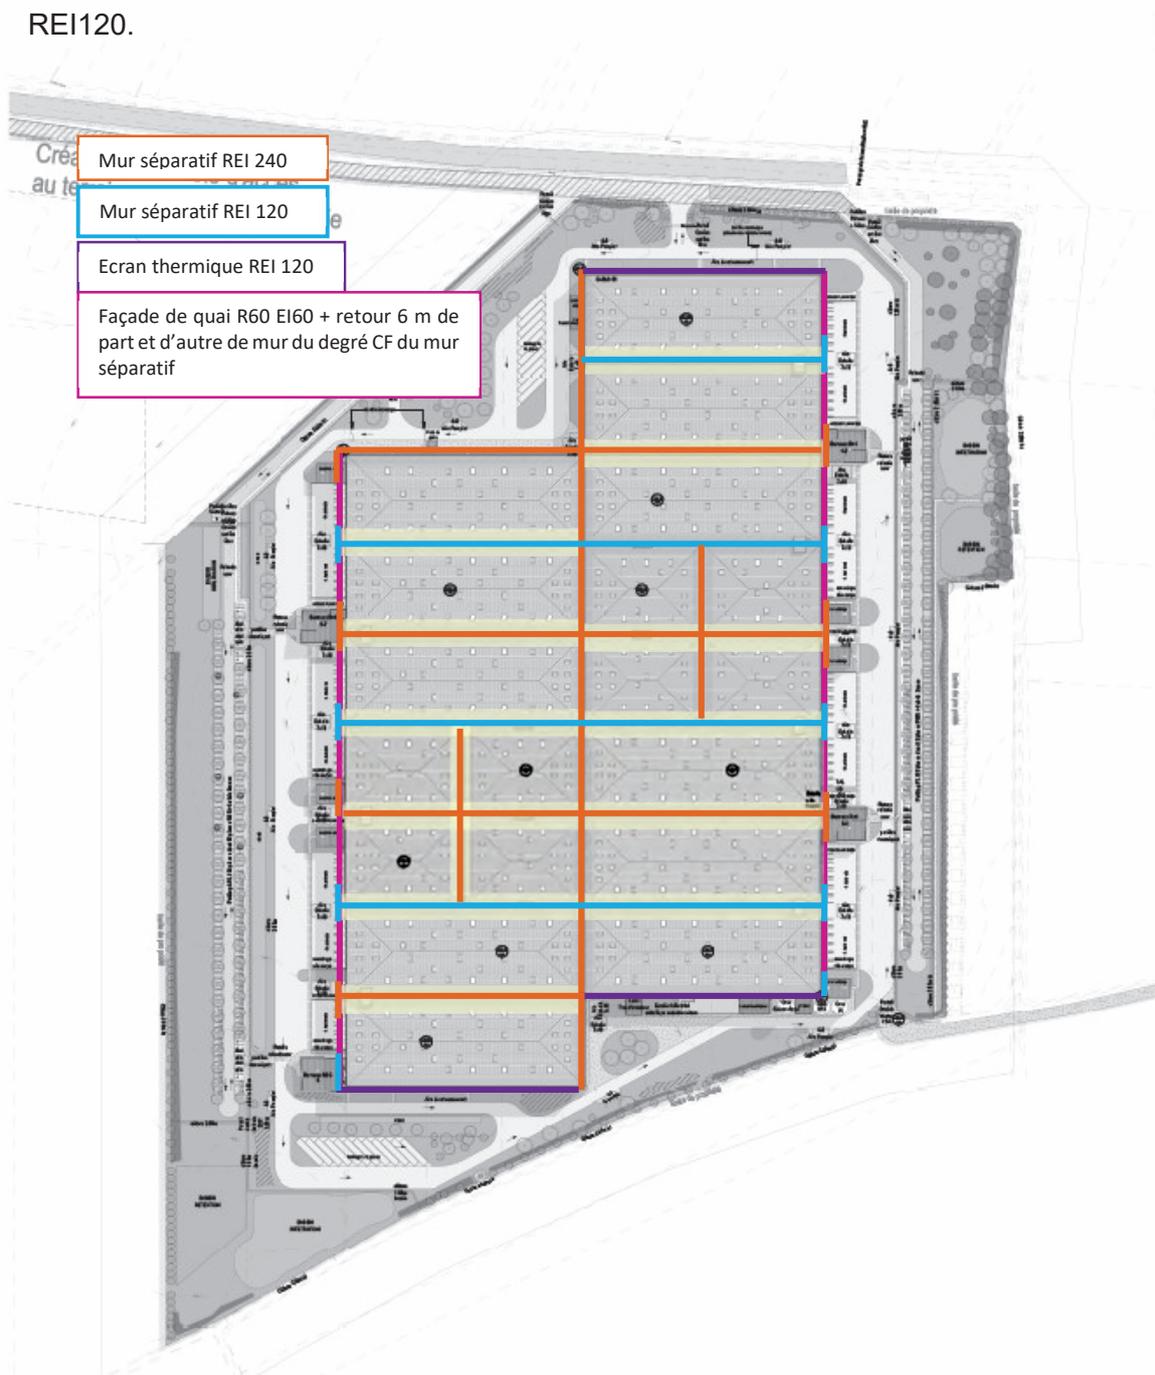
Plan de repérage des murs coupe-feu sur le bâtiment.
